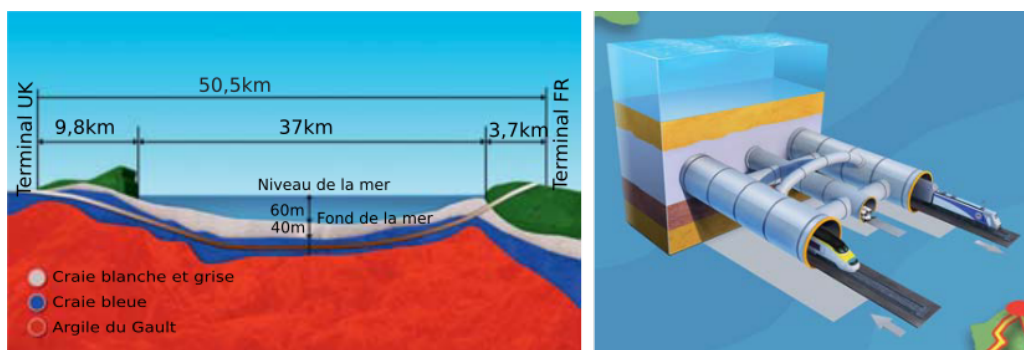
Tunnel sous la Manche (photo source : Eurotunnel.com)
